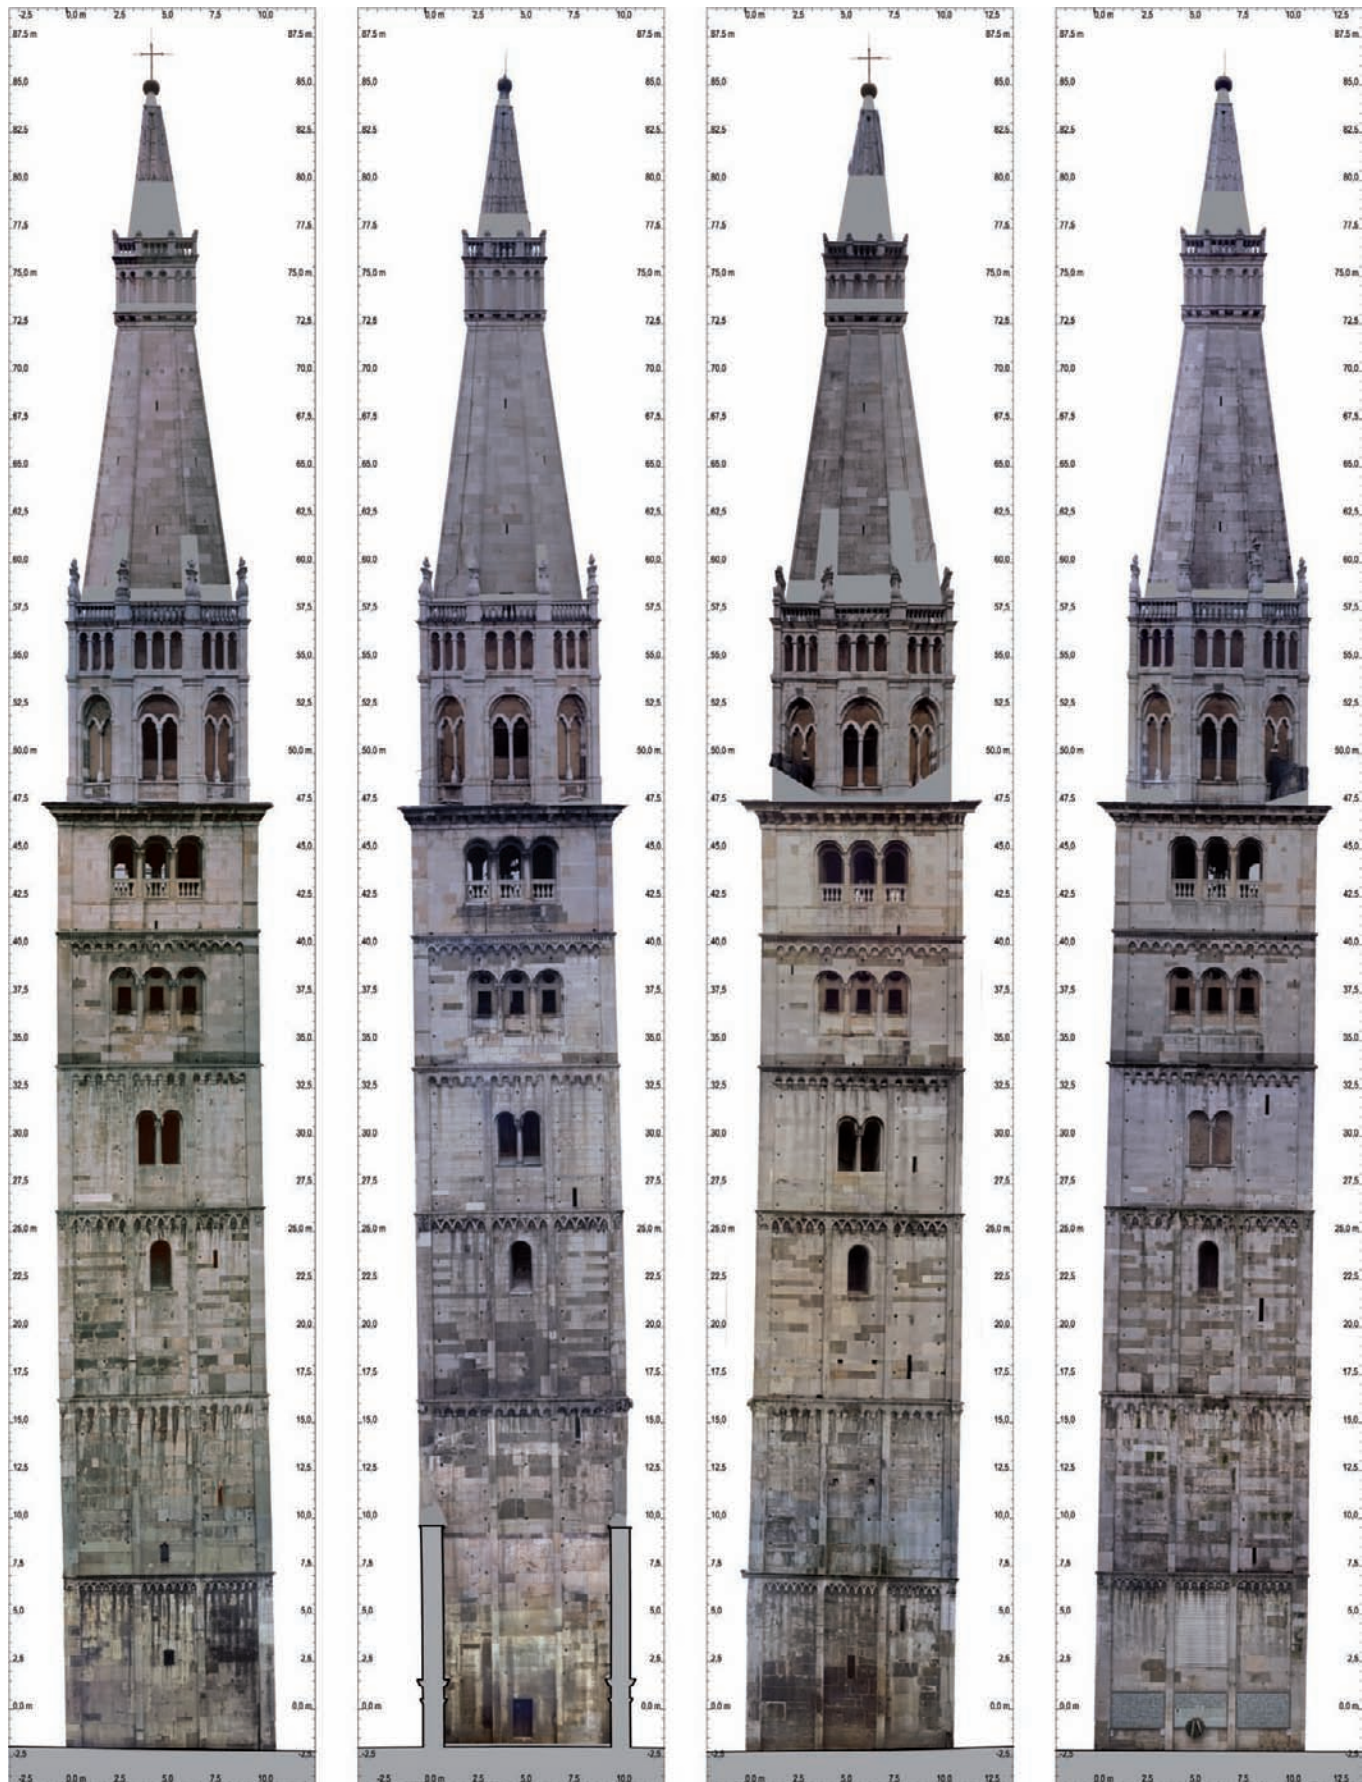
Fotopiani. Da sinistra: prospetto est, prospetto sud, prospetto ovest e prospetto nord.
